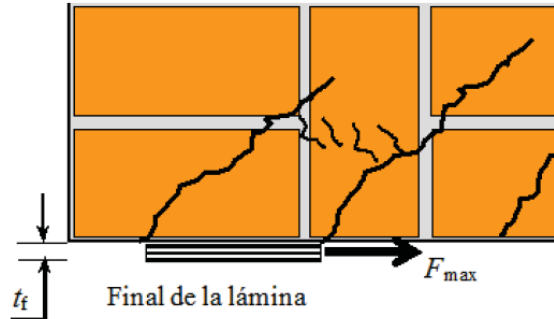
Falla debido al arrancamiento de la mampostería [30].
